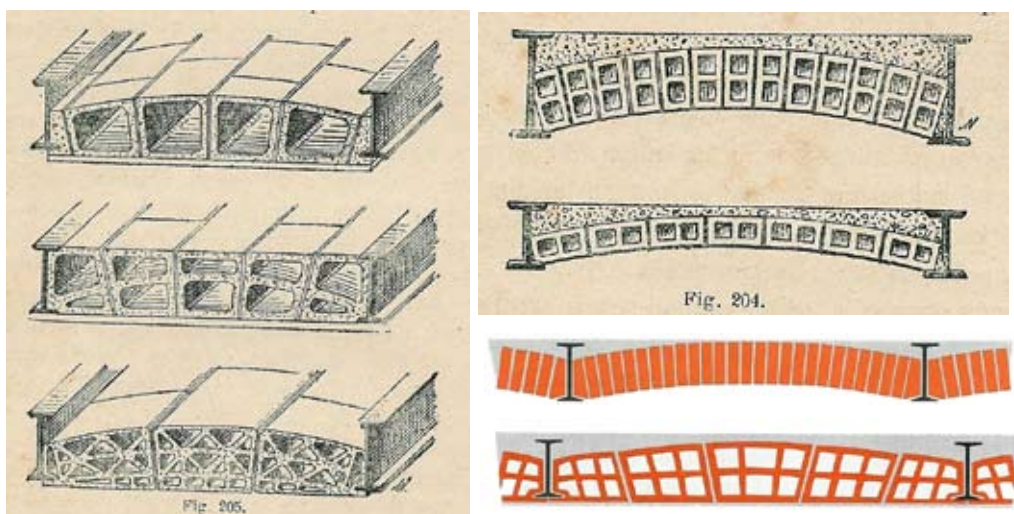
Solai della seconda metà dell'Ottocento: travi di ferro a doppio "T" (putrelle) con interposti elementi in laterizio.
